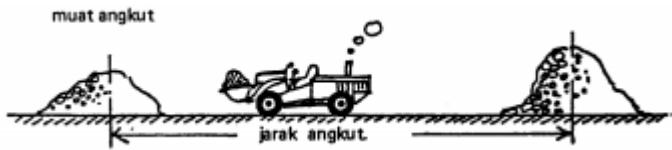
Wheel Loader dalam Pekerjaan Produksi Beton di Batching Plant
